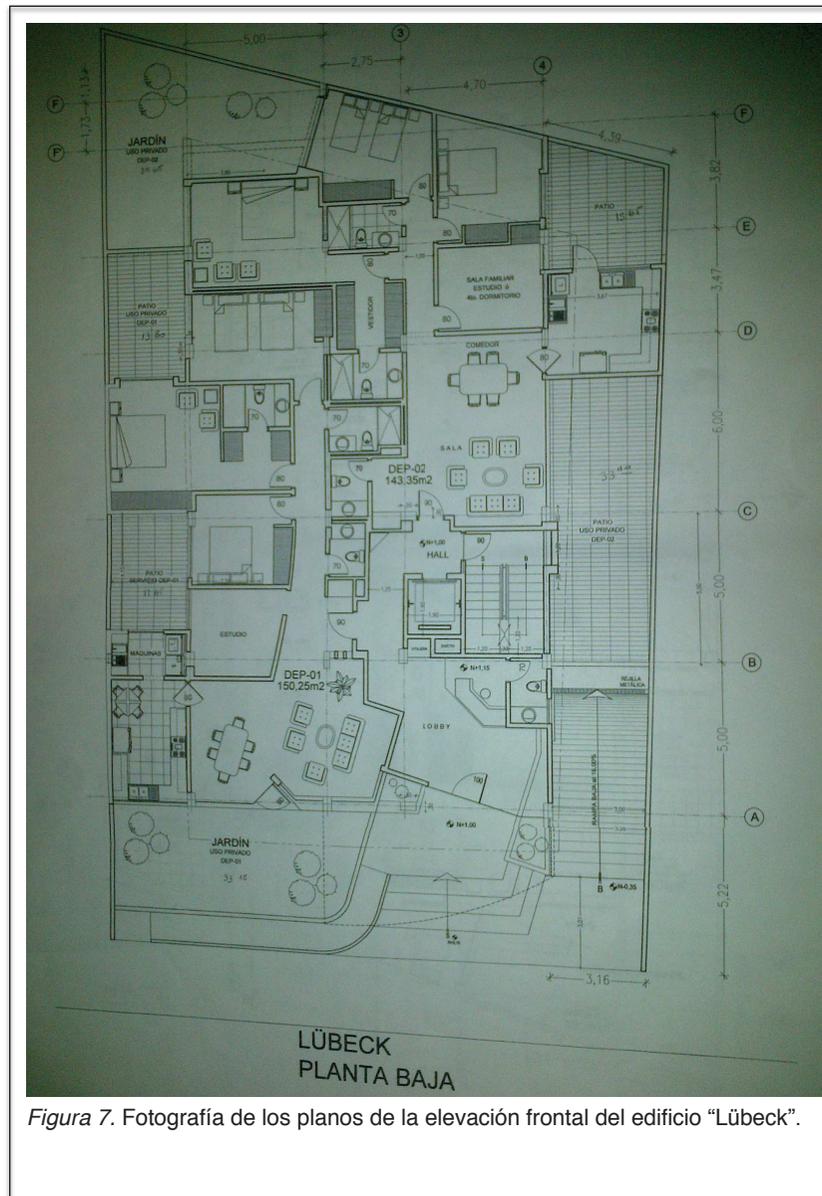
Fotografía de los planos de la elevación frontal del edificio "Lübeck".
